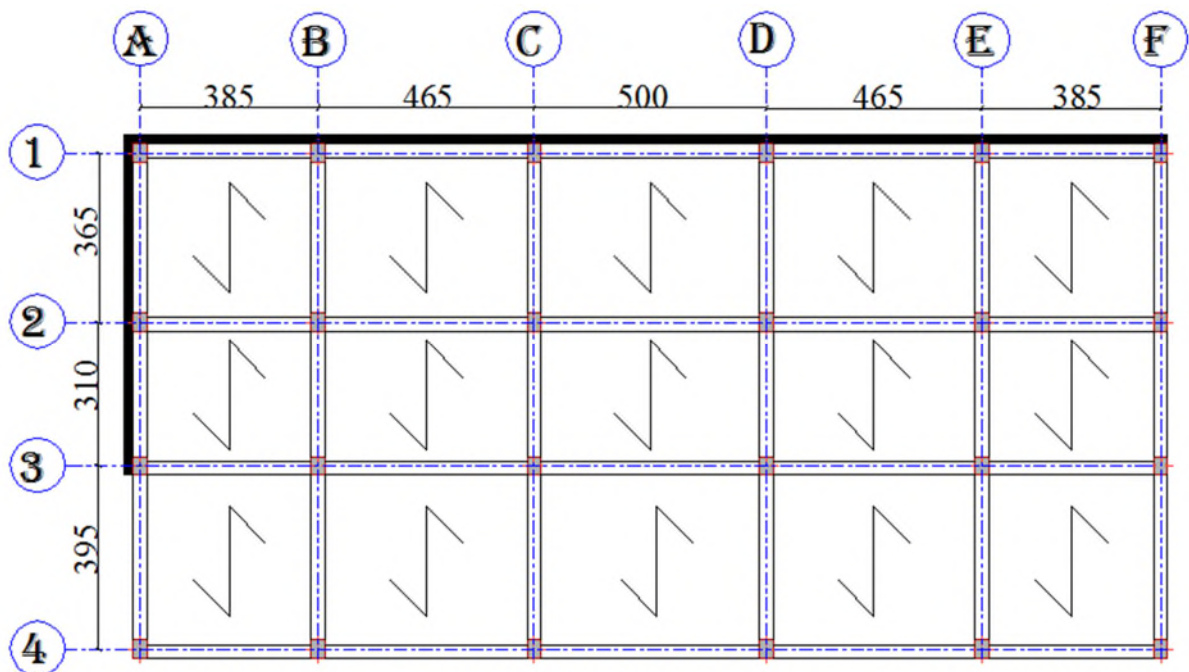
Plan de disposition des poutrelles (Étage commerce).
